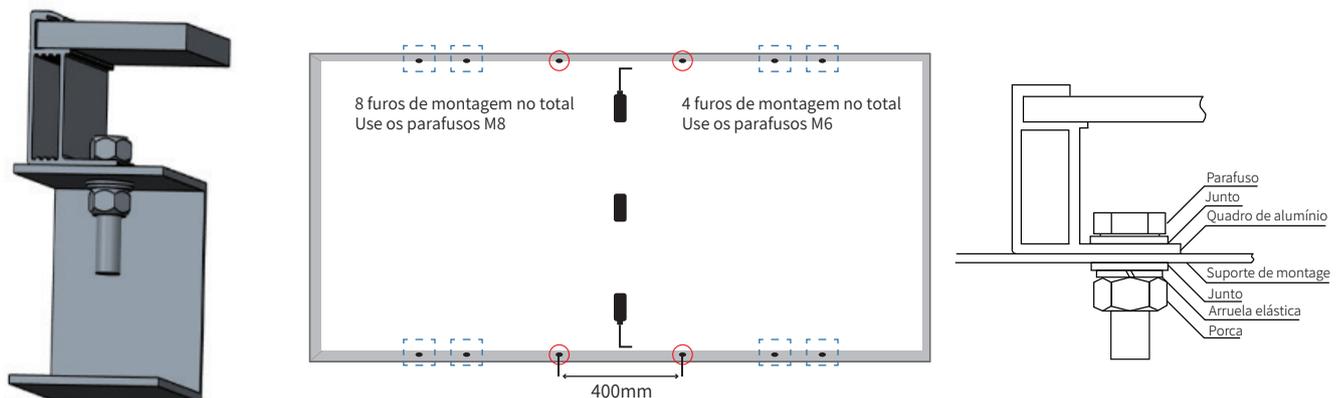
Ilustração de instalação de furo de montagem de componente de uma face
